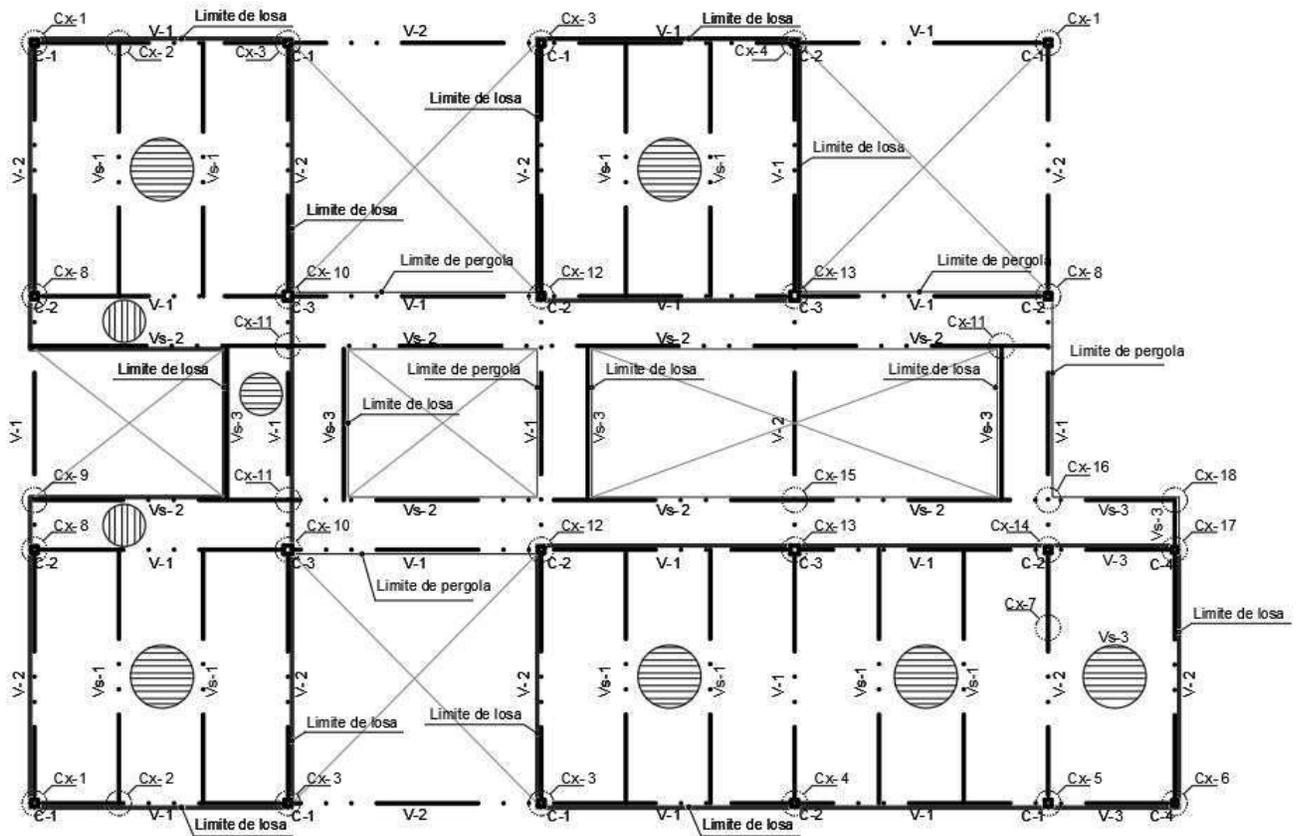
| Planta estructural de entresijos del 1er y 2do nivel de MUSAS zona de educación y acogida Realización propia. / 2023
